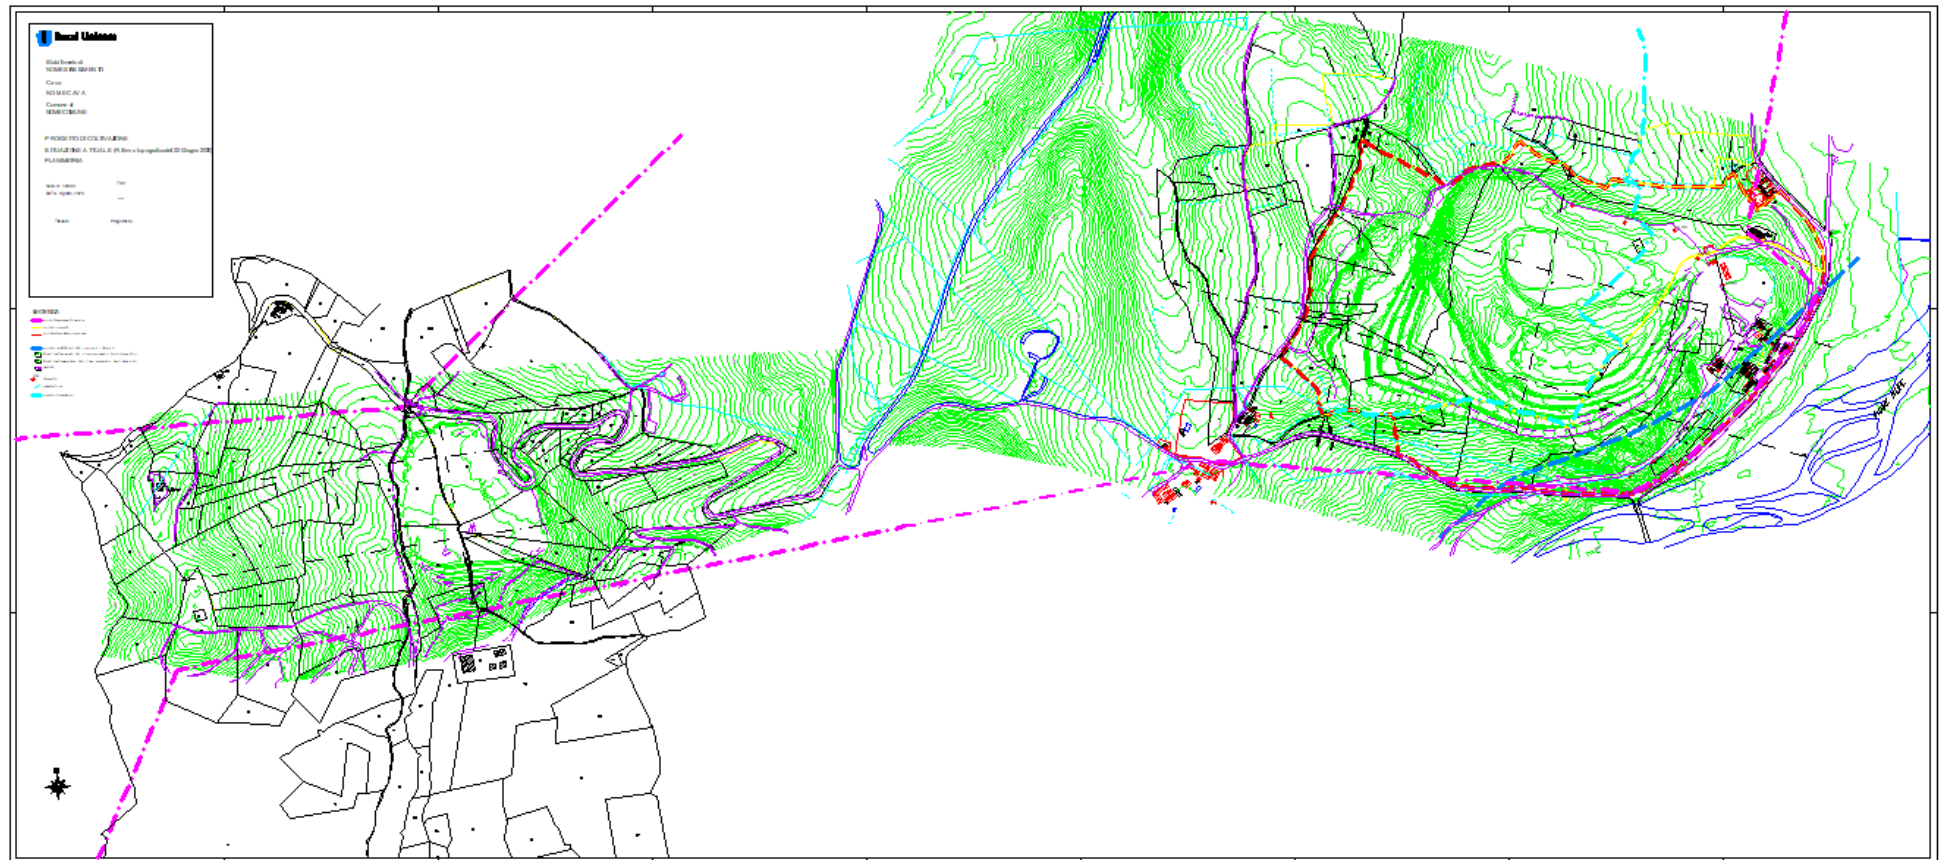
Planimetria di progetto - Fase 2 (10 anni)
